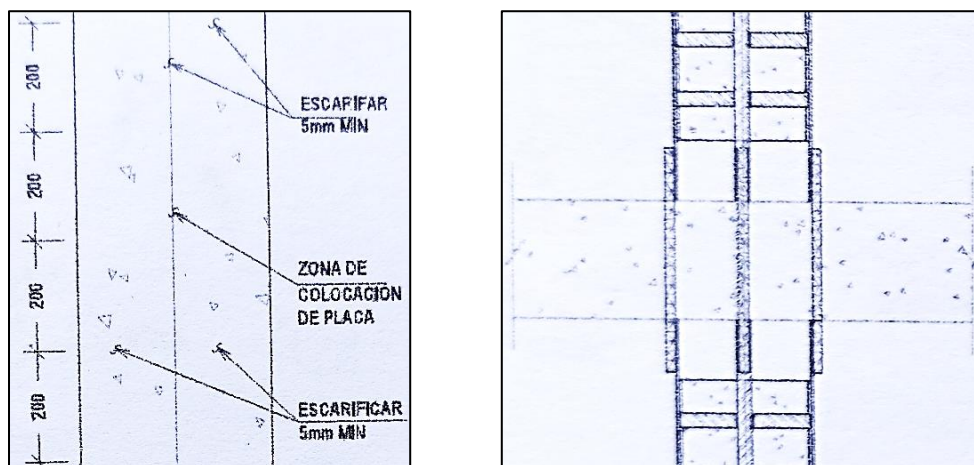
Zona de escarificación de la columna de concreto para el encamisado con ángulos y soleras, tomado de los planos estructurales de Gómez González (2020).
